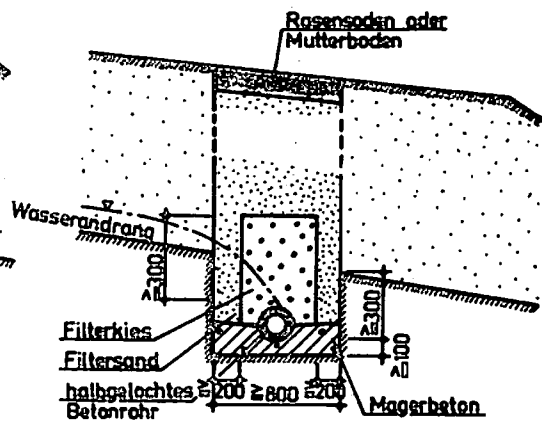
Längstiefensicker mit halbgelochten Betonrohren bei Schichtenwasserandrang
